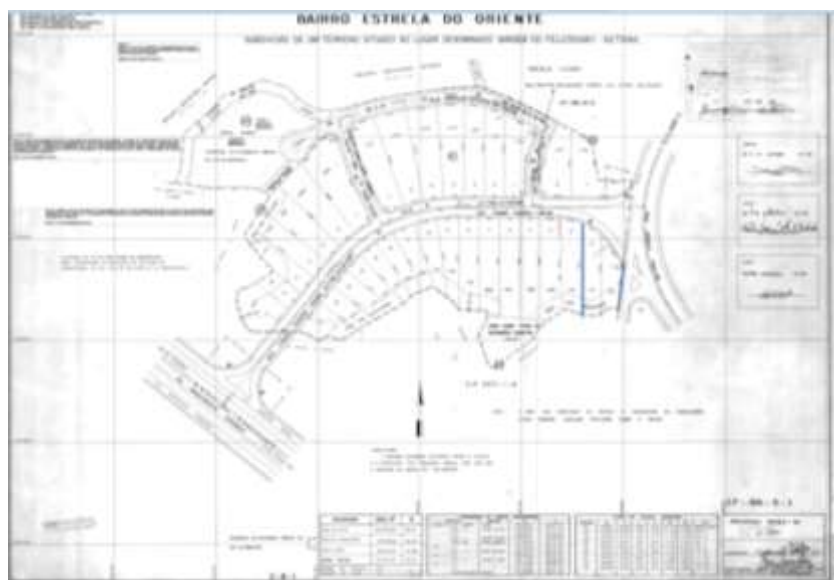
Planta CP onde nota-se a não demarcação da APP, mas a existência da área não edificante.
